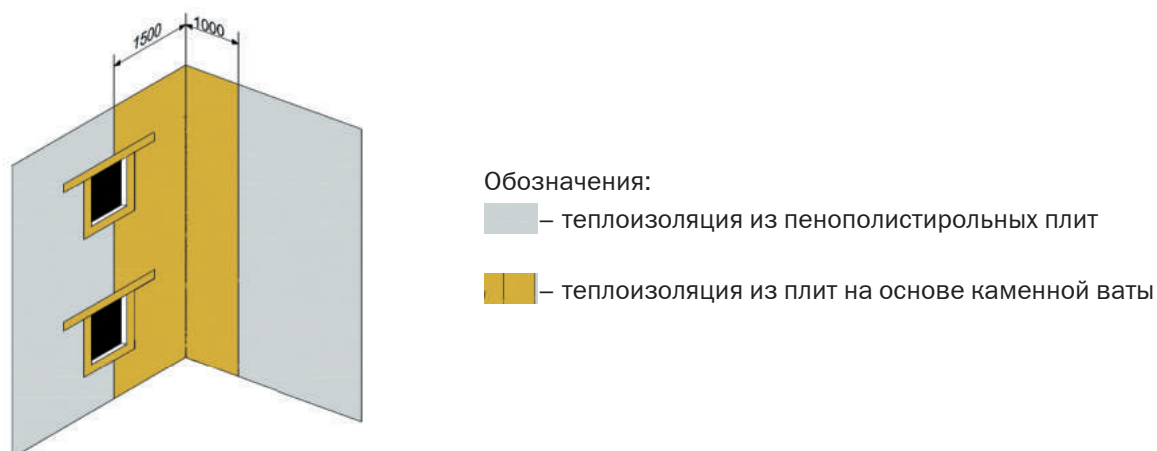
Размещение теплоизоляционных плит в зоне внутреннего угла, при наличии проемов
